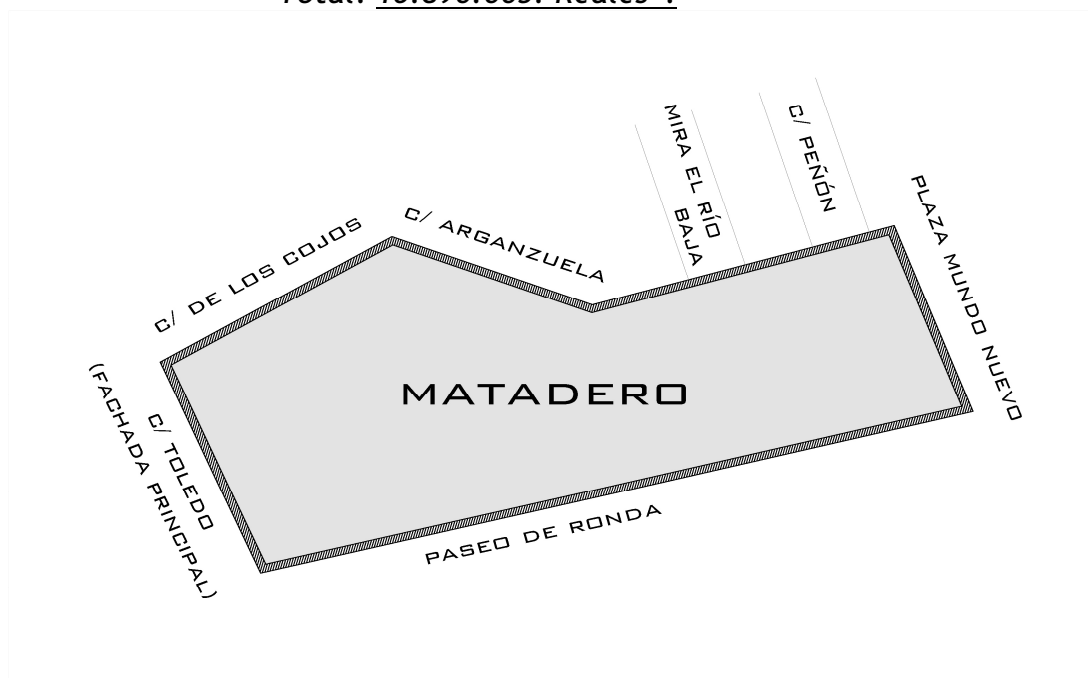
Plano de planta del proyecto General del Matadero Público de Madrid. 1861²⁷¹
